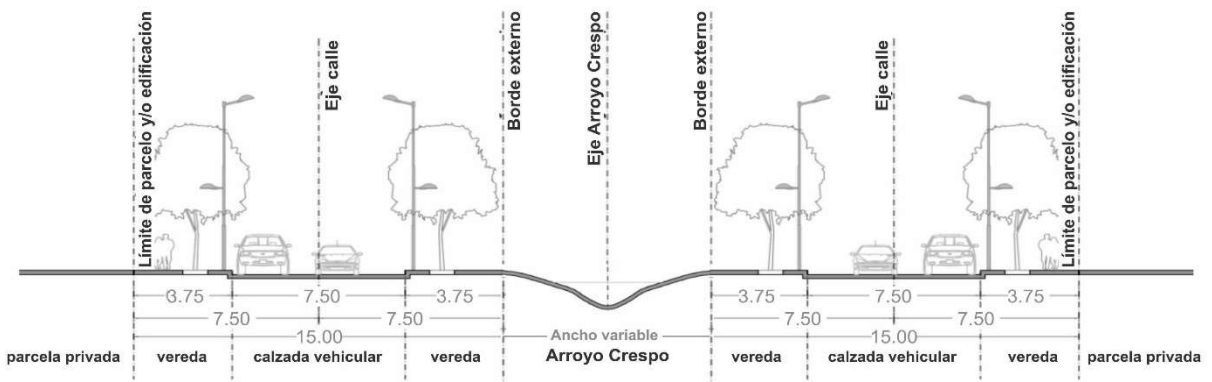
Sección transversal de Vías Especiales Tipo 4.
